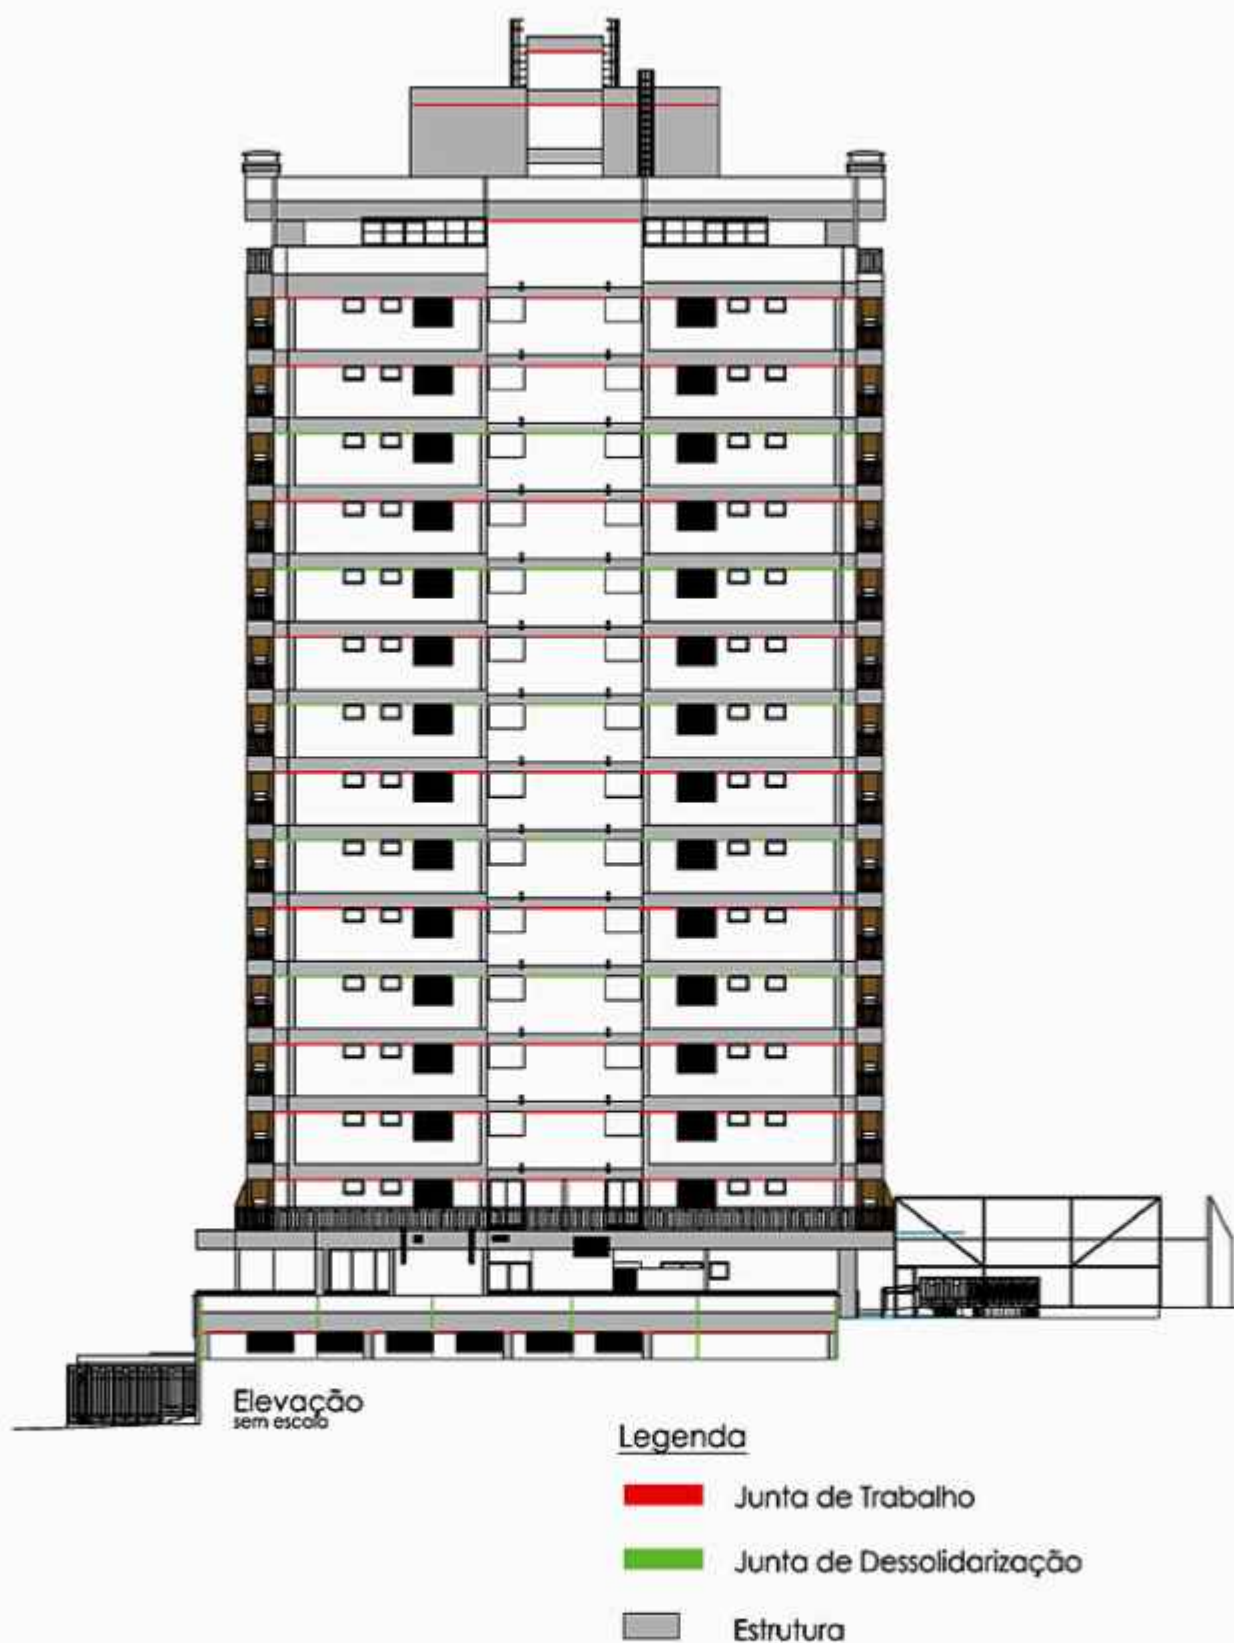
Exemplo de posicionamento de juntas de movimentação em projeto – elevação.
